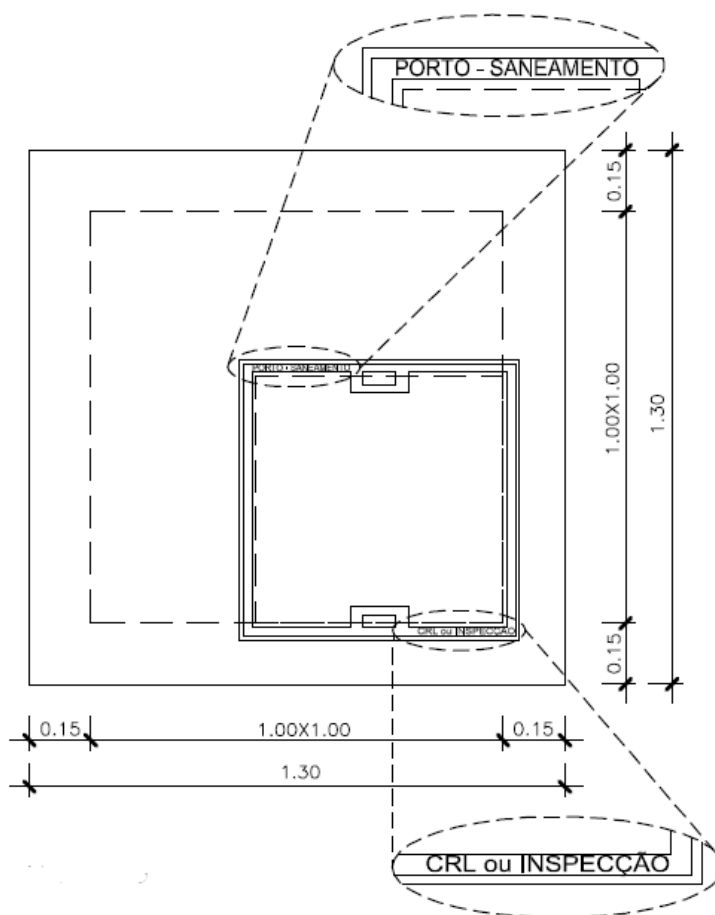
Dimensões em planta de uma CRL em betão
